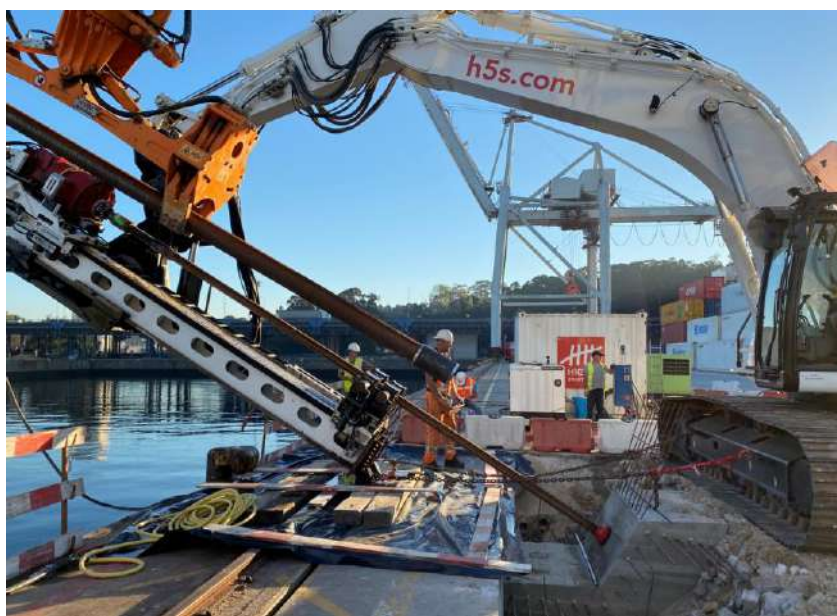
Execução da ancoragem autoperfurante teste, utilizando um troço de viga de encabeçamento como estrutura de reação
